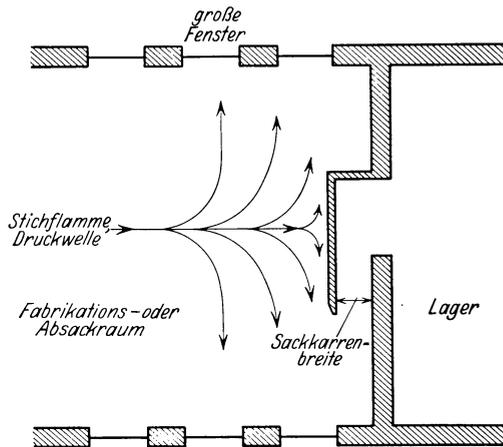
Zweckmäßige Verbindung gleicher Stockwerke benachbarter Bauten.
